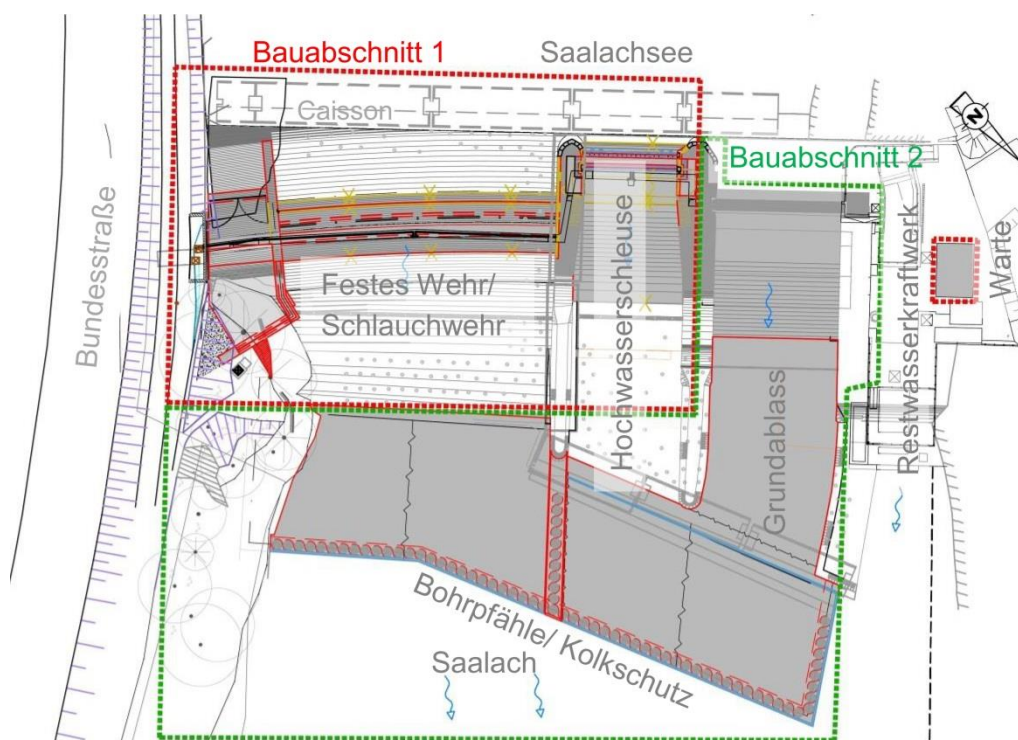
Wehranlage mit Bauabschnitten in der Übersicht
